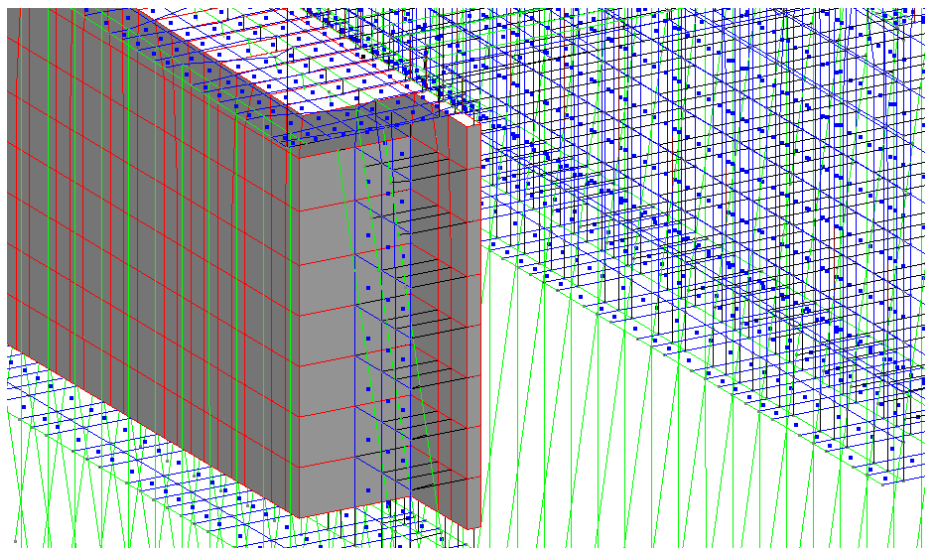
Modello 3D - Particolare dell'attacco tra la spalla esistente e la nuova con i tiranti
